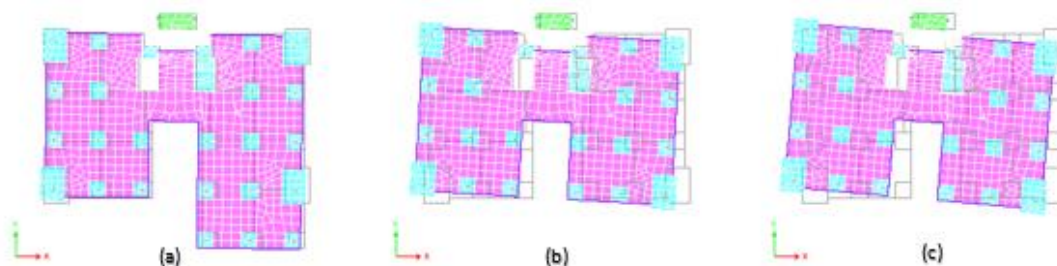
Vista en planta del modo de vibración 1 correspondiente al Caso 2. a) Segunda Planta. b) Quinta Planta. c) Octava Planta.
